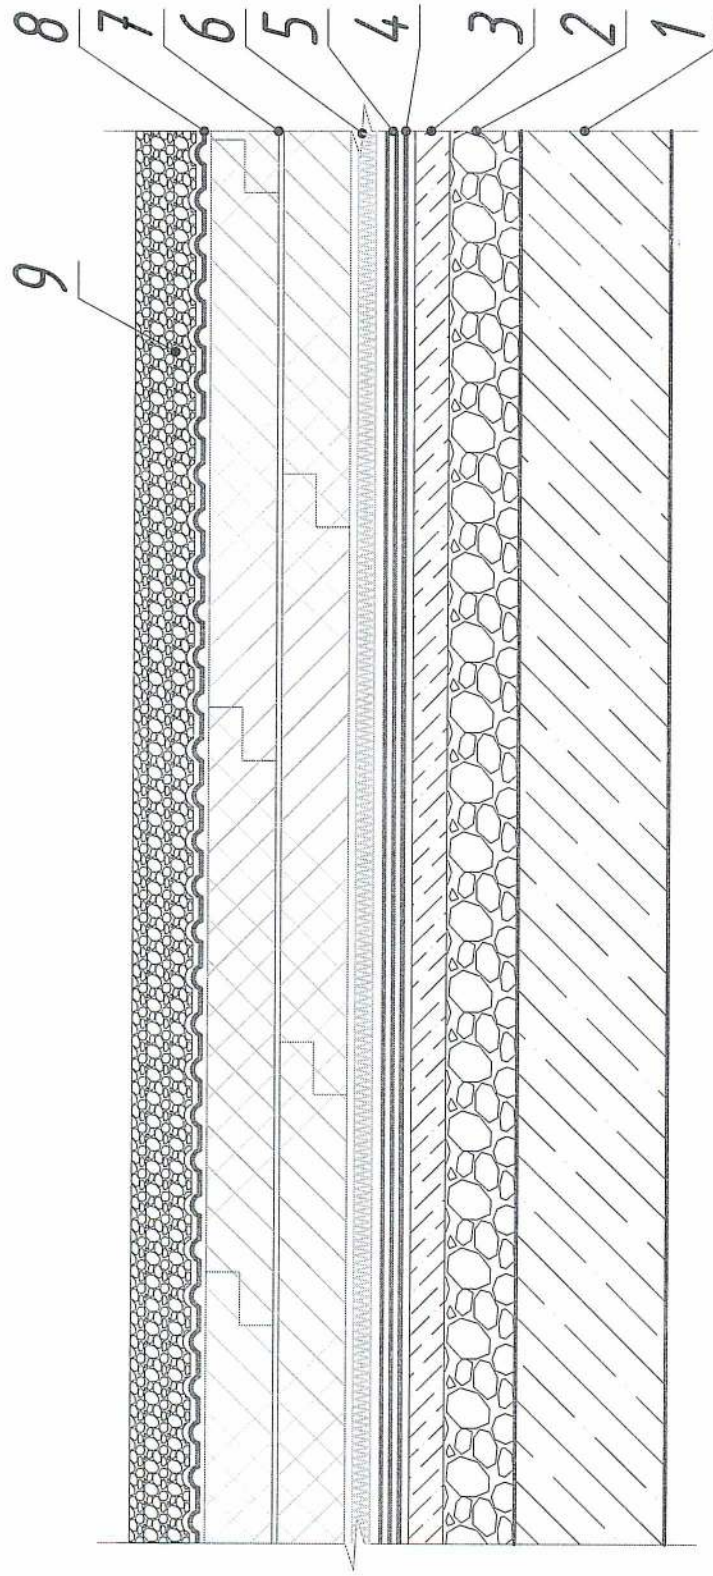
Принципиальная схема конструктивного исполнения настила бесчердачного покрытия выполняемого по железобетонному основанию (инверсионная неэксплуатируемая кровля)
